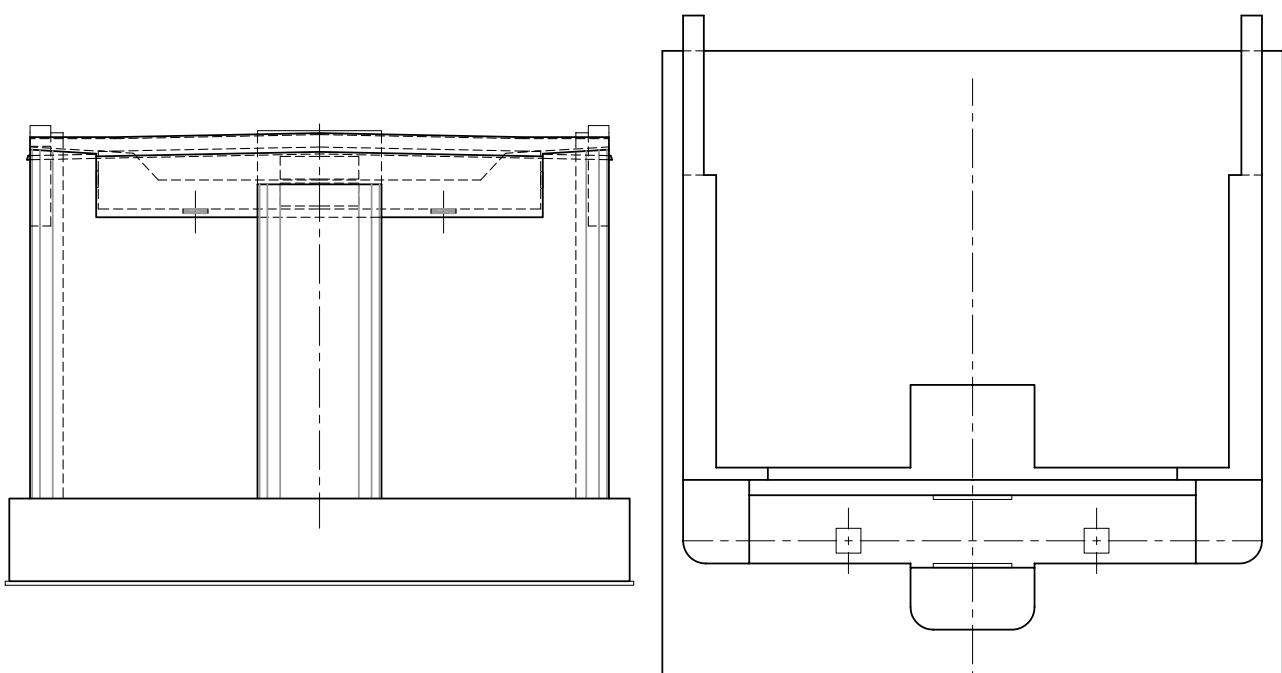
Estribo fijo de tablero tipo losa pretensada. Alzado y planta
